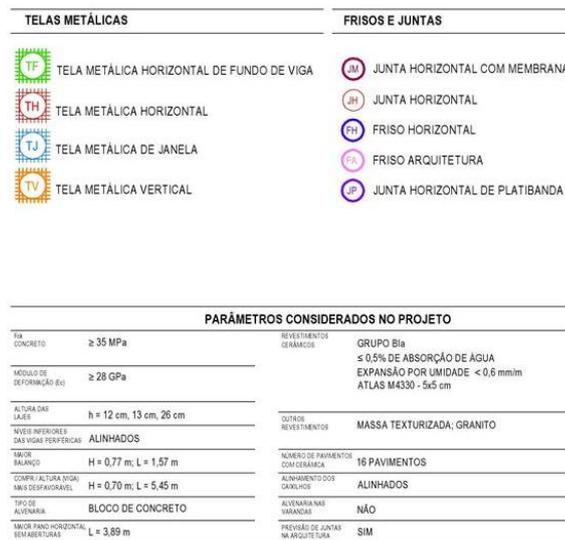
Projeto para produção de fachada: Planta de telas de juntas de reforço (Fonte: Site da empresa Inovatec Consultores Associados – acesso em 21/03/2018)
